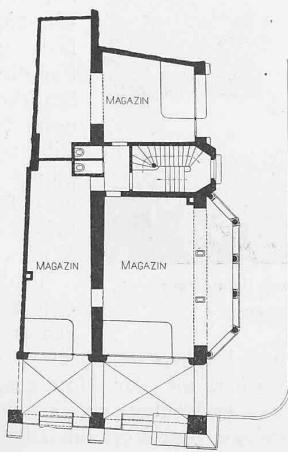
u. 3. Grundrisse vom Erdgeschoss und Obergeschoss des Neubaues.
